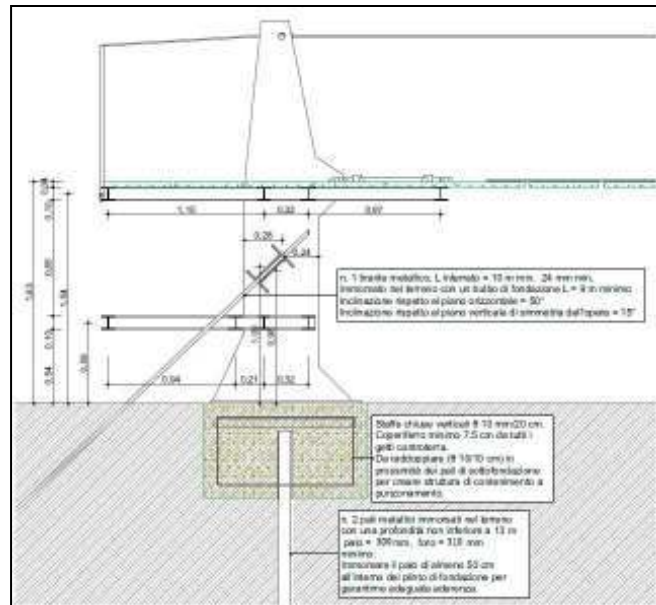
Prospetto indicativo della posizione dei tiranti di ancoraggio
